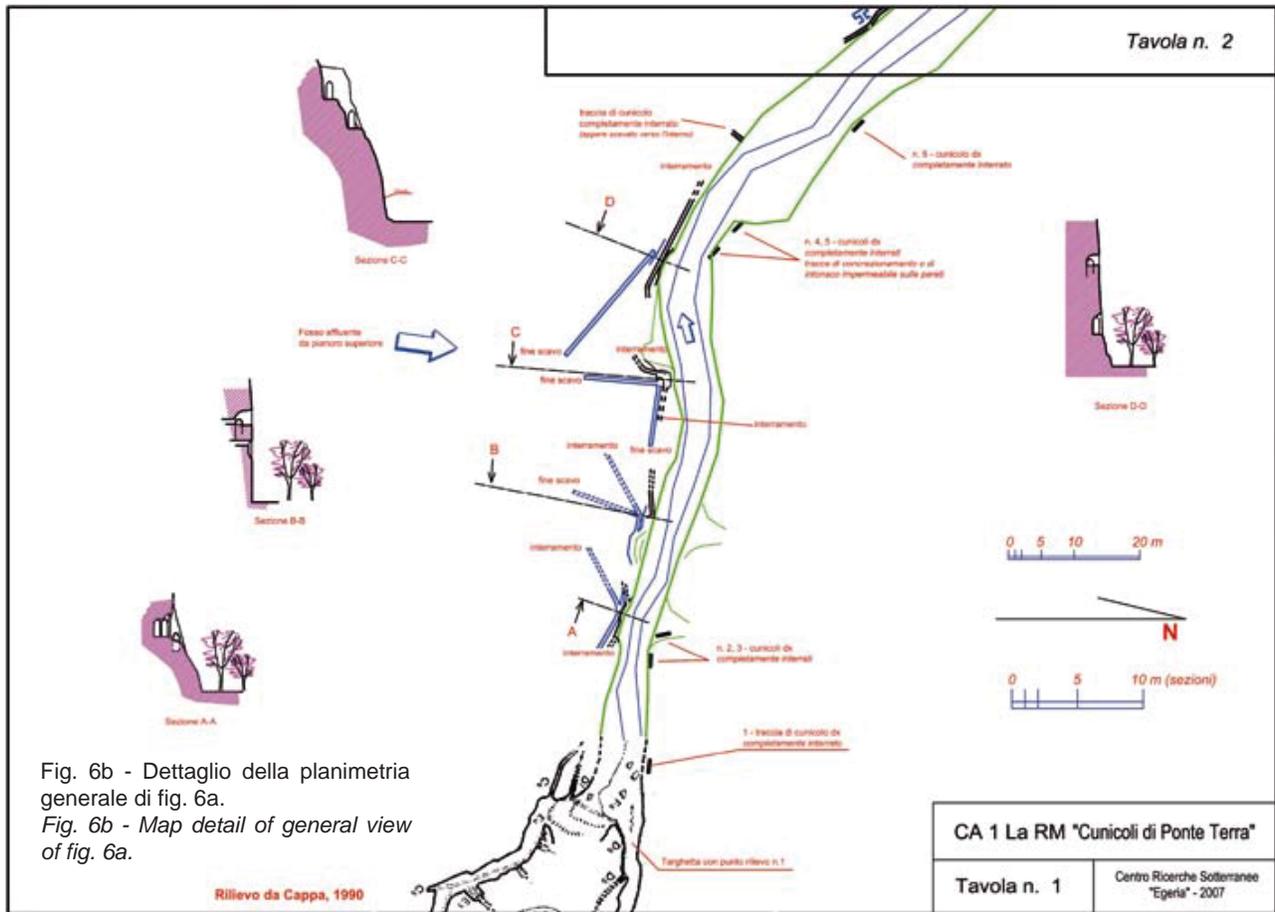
Dettaglio della planimetria generale di fig. 6a.
